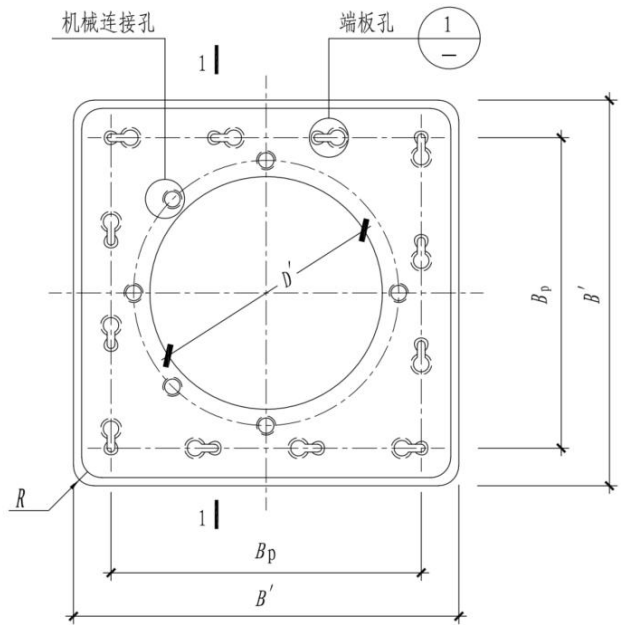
抗拔空心方桩Ⅱ型接头端板平面图
